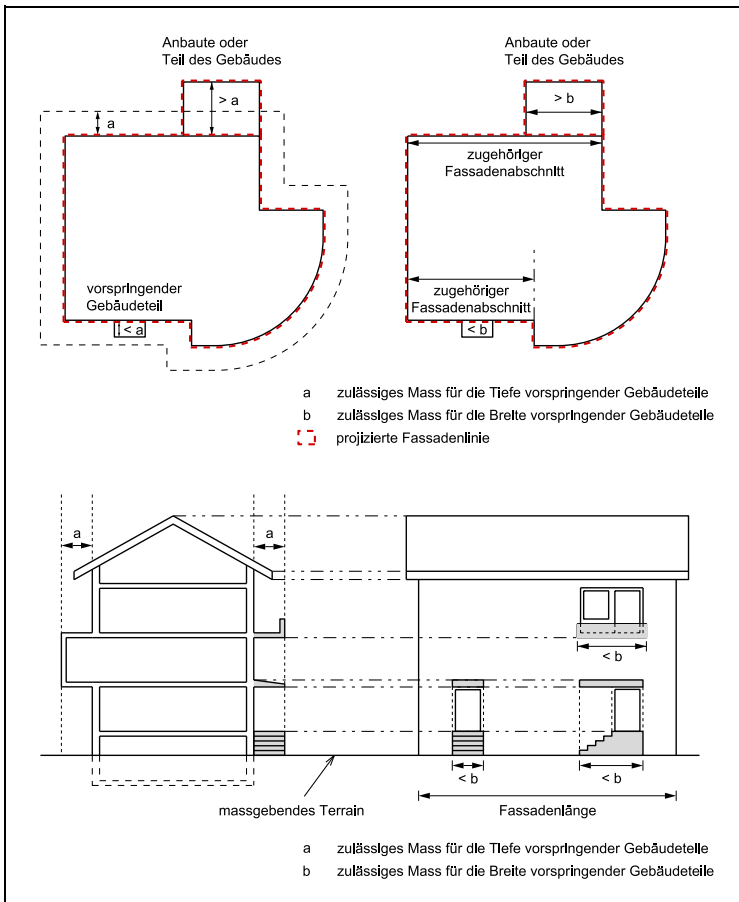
und 3.2 Fassadenflucht und Fassadenlinie (§§ 6, 6 a ABV)
